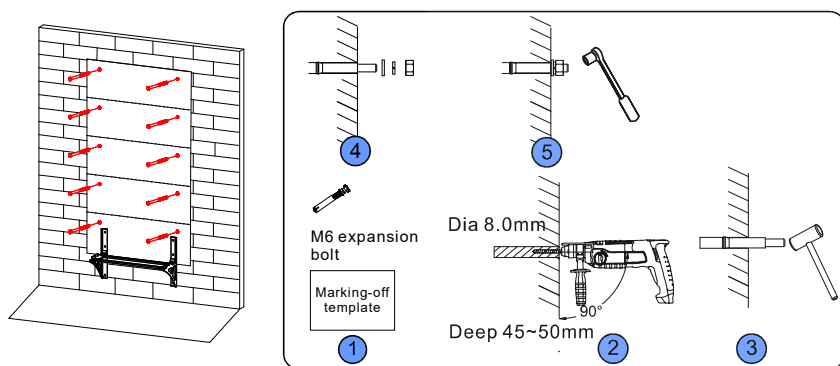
Určete pozice otvorů pro instalaci držáku
